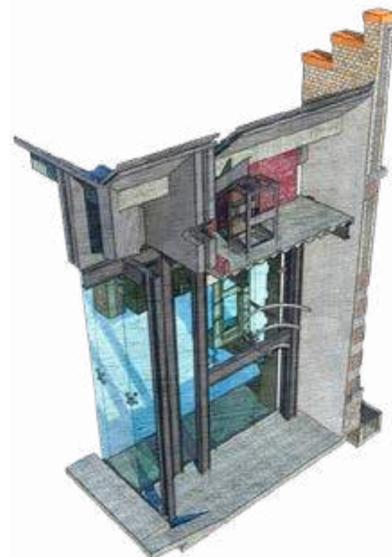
Isométrico ilustrado - Interior - Consolidación fachada Sur.
